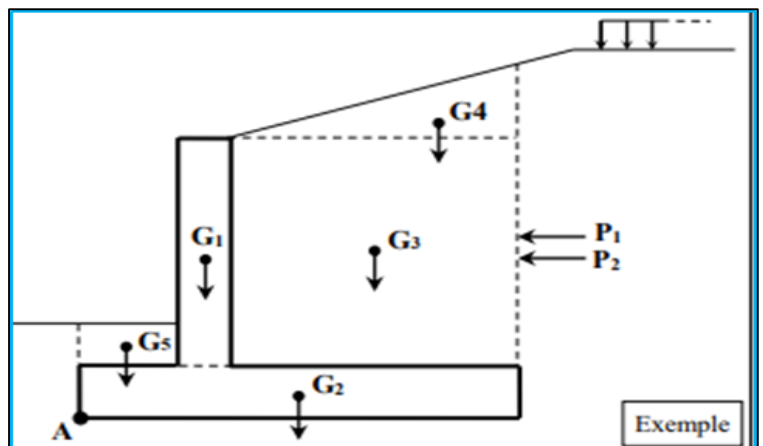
Exemple de disposition de la charge (les murs de soutènement ,2013
